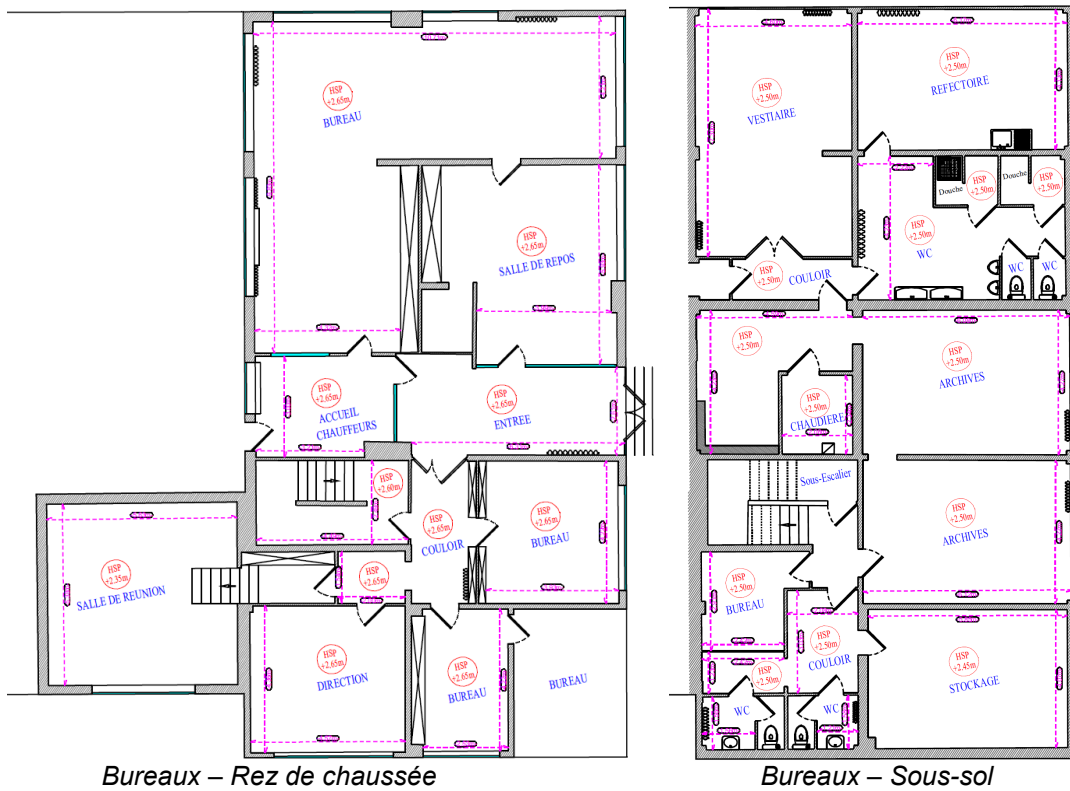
PLAN DU BATIMENT CENTRAL
